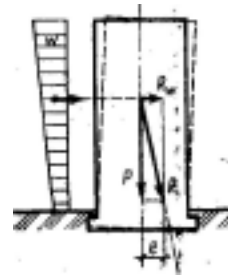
Схема устойчивой работы здания на ветровую нагрузку:
